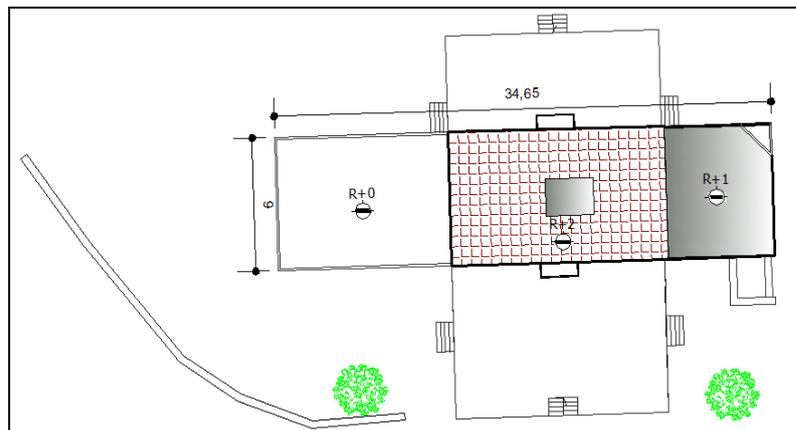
, la position du mur par rapport au bâtiment, source : Ep
